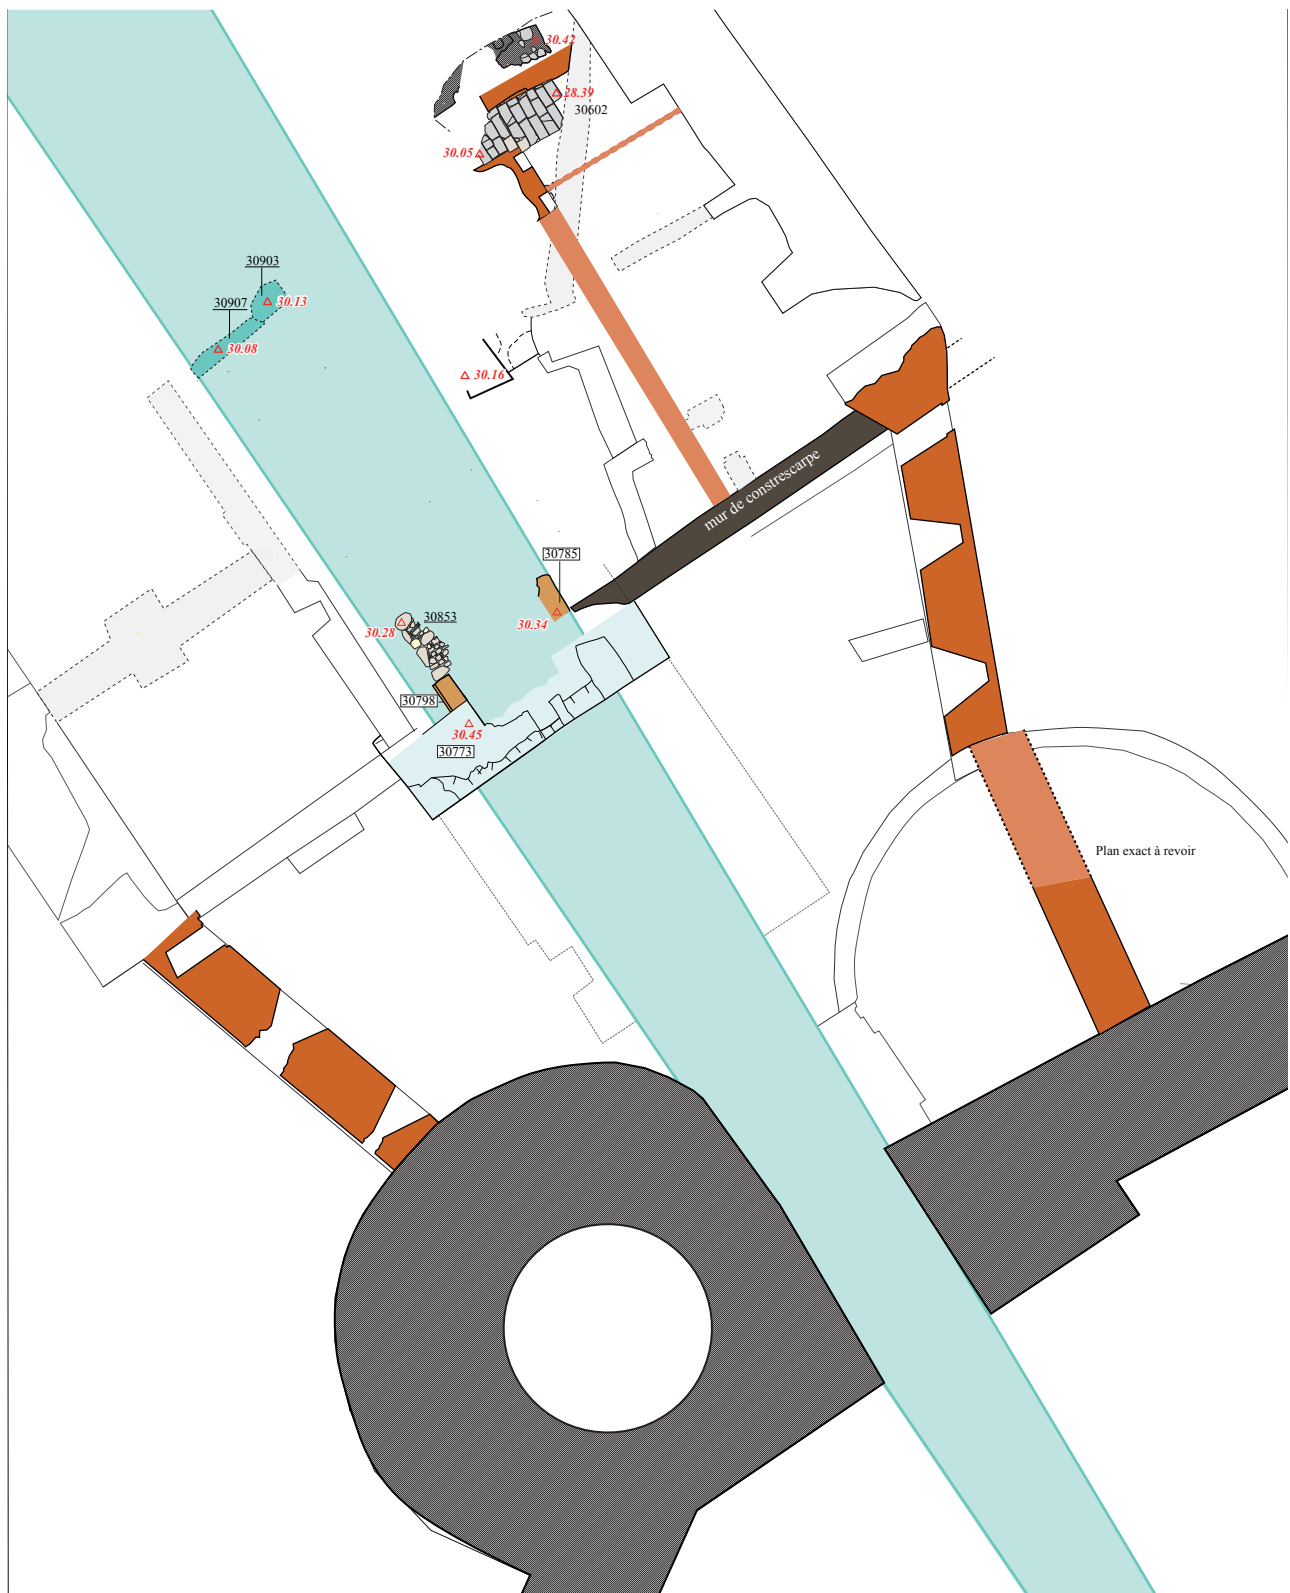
La reconstruction du départ de pont suivant le plan précédent © E. Esnault Inrap
